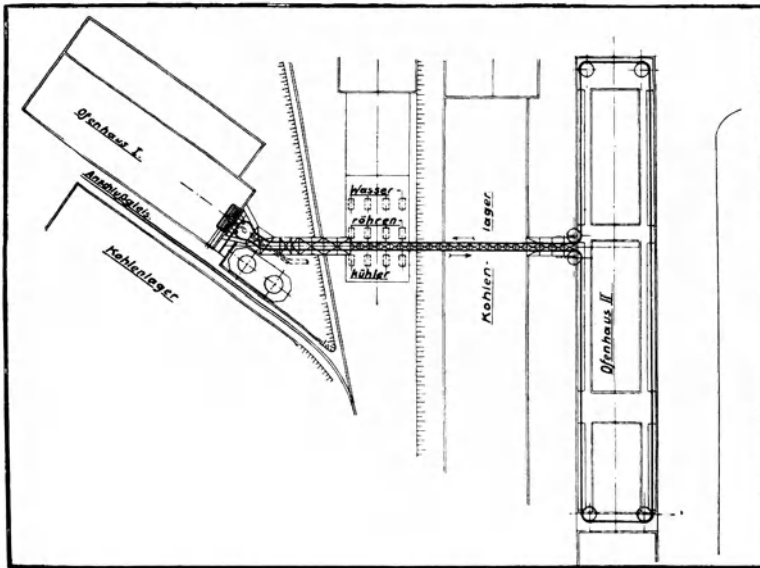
Lageplan der Anlage im Gaswerk Dresden-Reick (Mackensen).
